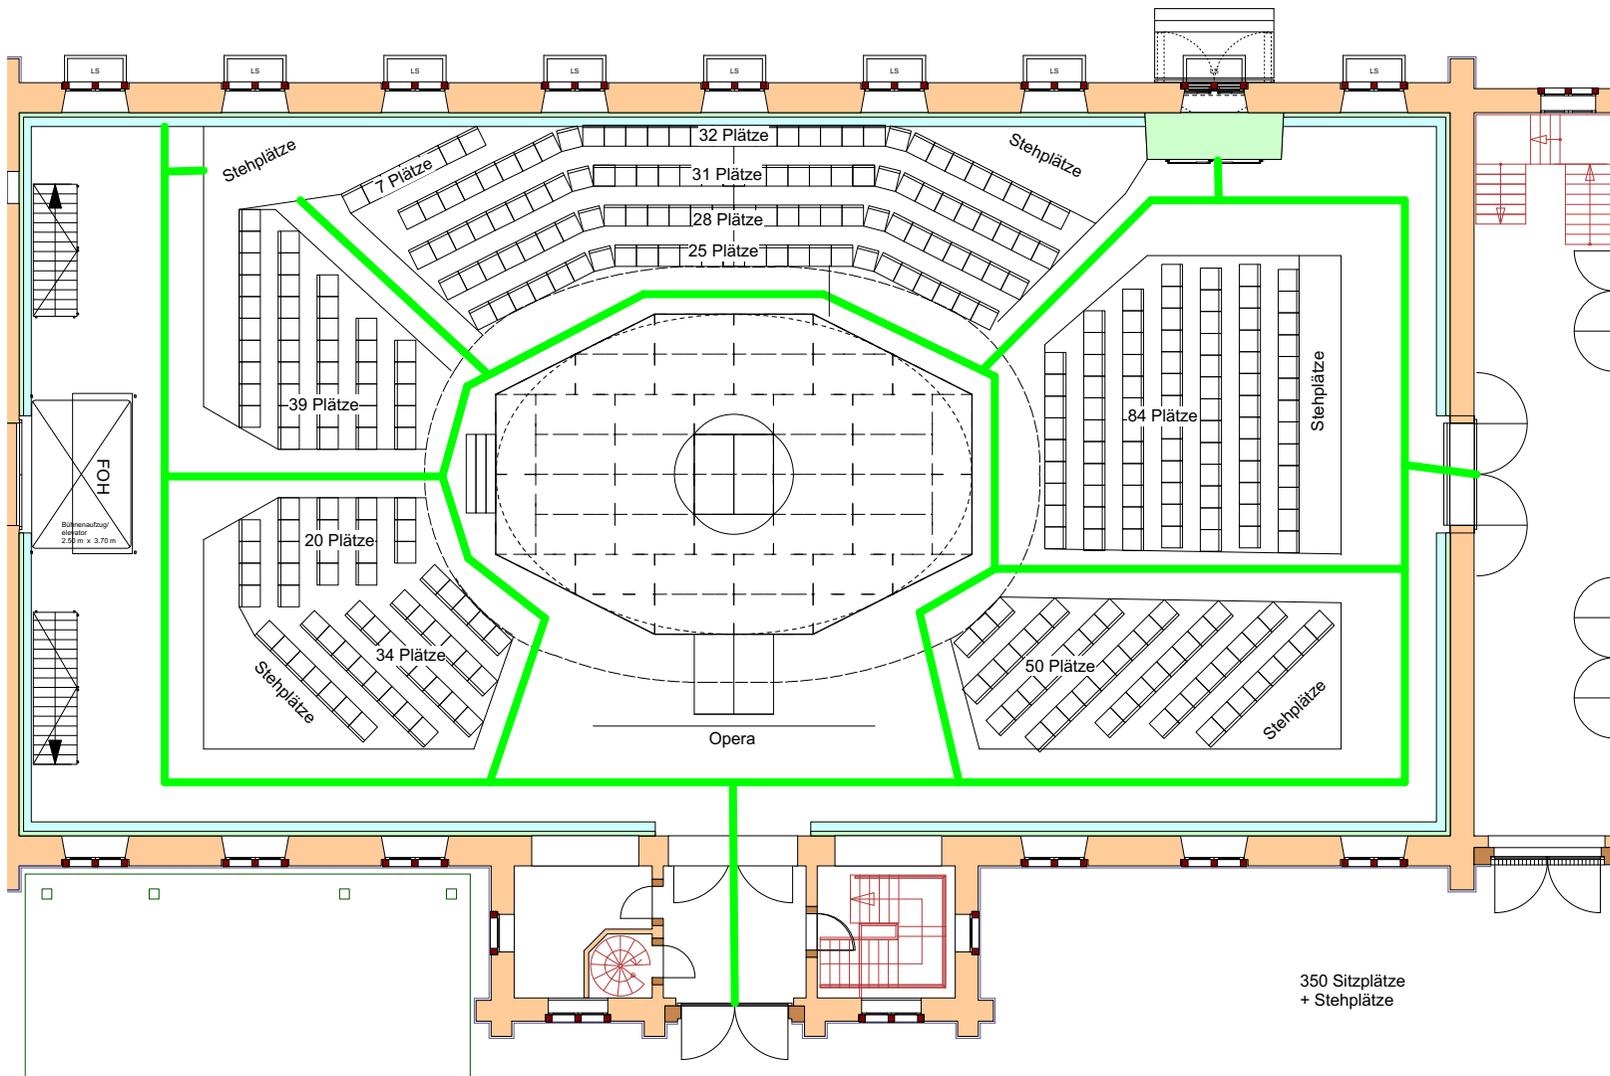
Grundriss der Reithalle der Kaserne Basel bei der Uraufführung von *Oh Albert*. Datei „Grundriss\_Reithalle\_OhAlbert\_v2016neuIV“, 2016. Im Folgenden mit „*Oh Albert*, Grundriss Reithalle“ abgekürzt.
